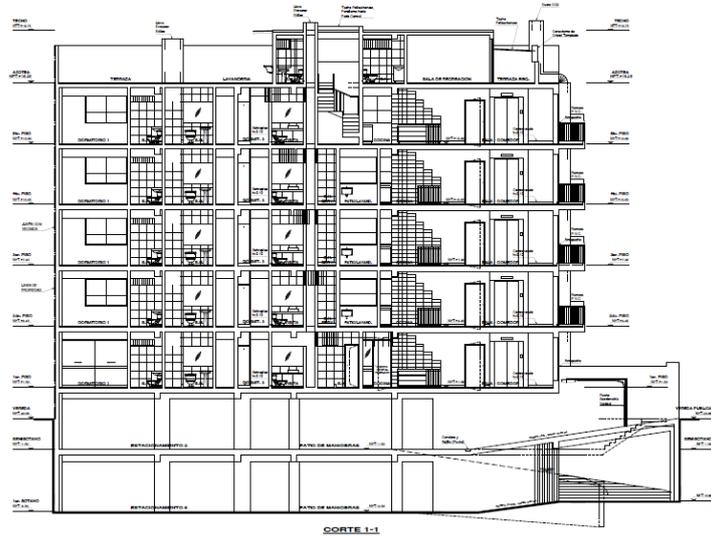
Plano de Elevación lateral 2D Edificio Spuknit - Surco
